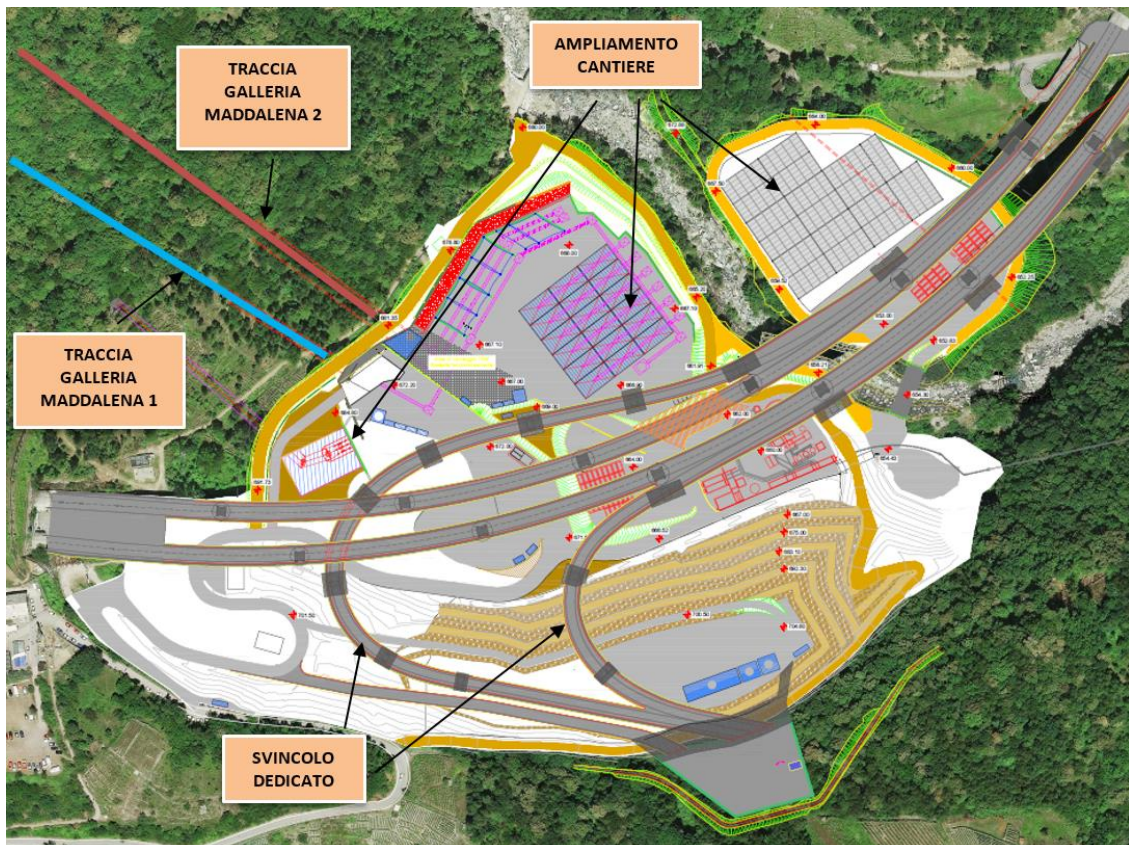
Planimetria della configurazione di progetto dell'ampliamento del cantiere de La Maddalena per la realizzazione del cantiere operativo 4, nella sua massima estensione.
